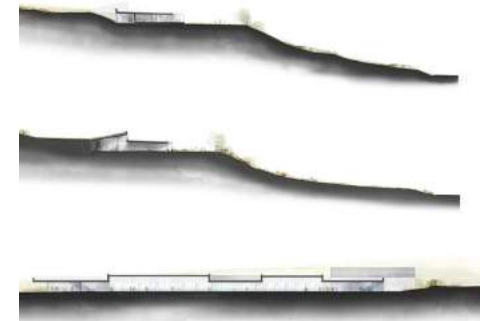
Infografía del proyecto y su emplazamiento. RCR architects, 2010.
